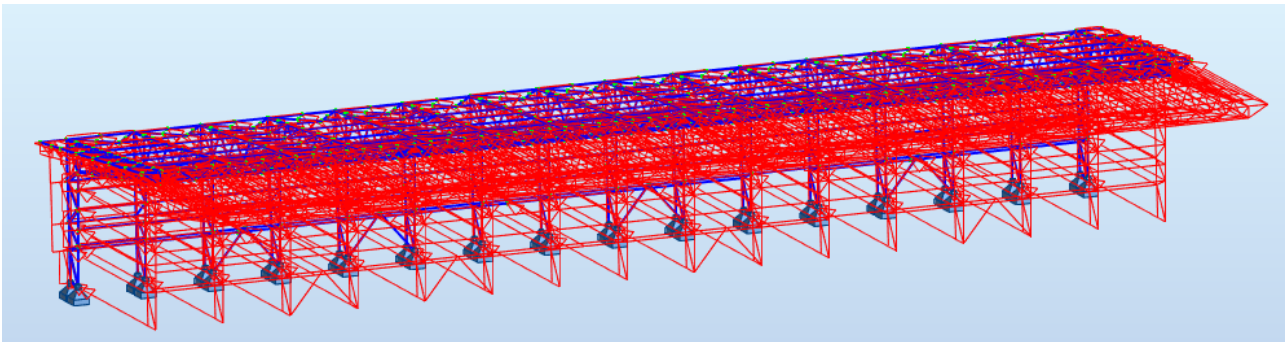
Djelovanje stalnog opterećenja na konstrukciju (pokrov + instalacije)
